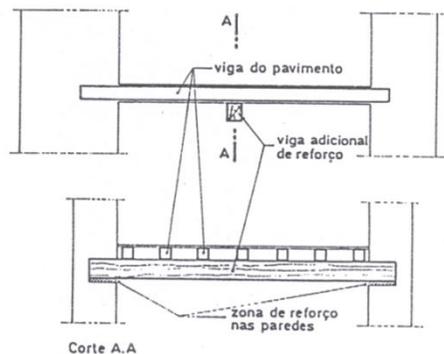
Redução de flechas de pavimento de madeira pela colocação de viga transversal ao vigamento do pavimento
